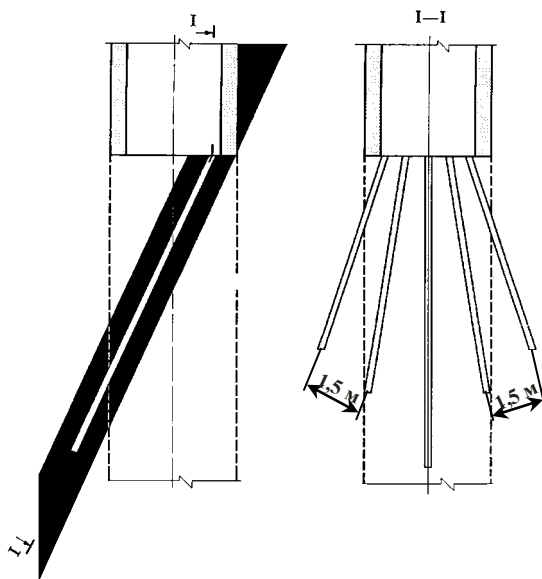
Схема розташування дренажних свердловин при перетинанні крутих і крутопохилих пластів.
